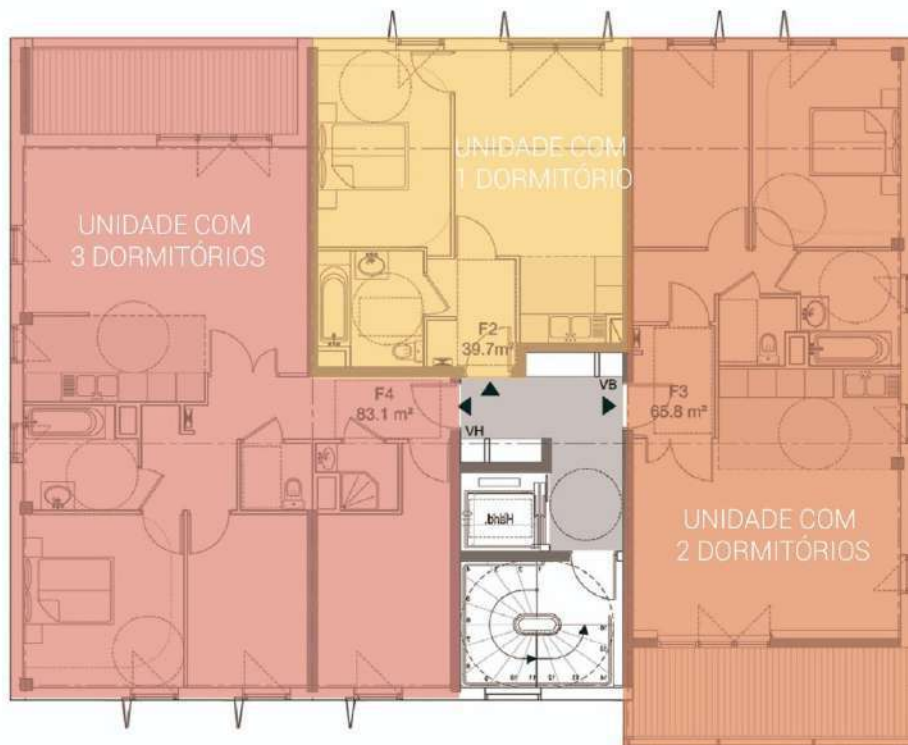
Planta pavimento tipo bloco com quatro unidades habitacionais
